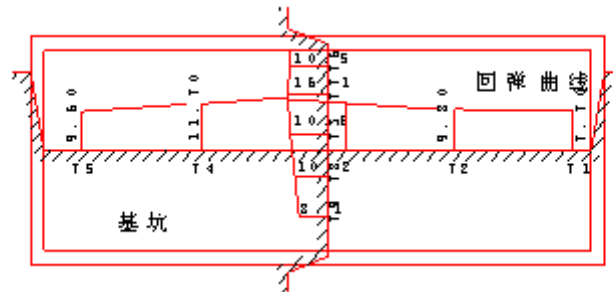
某楼基坑回弹量纵横断面示例(单位: mm)
